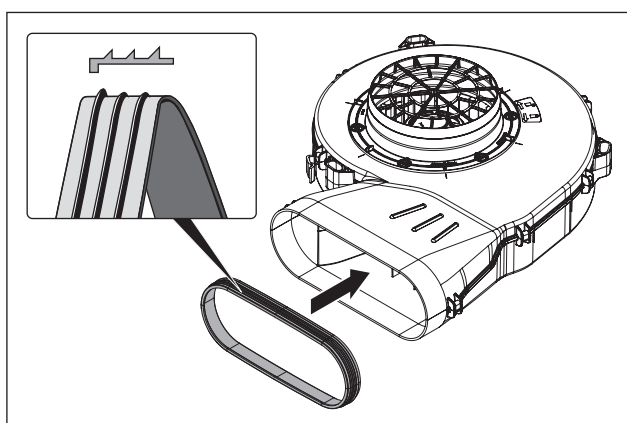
Colocar o vedante na conexão de saída do ventilador de rodapé
